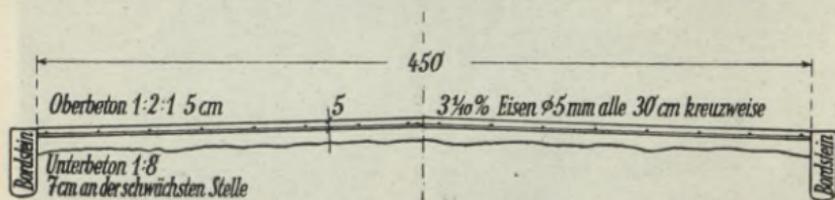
Betonversuchsstraße Groß-Salze-Felgeleben. Straßenquerschnitt 1926.
